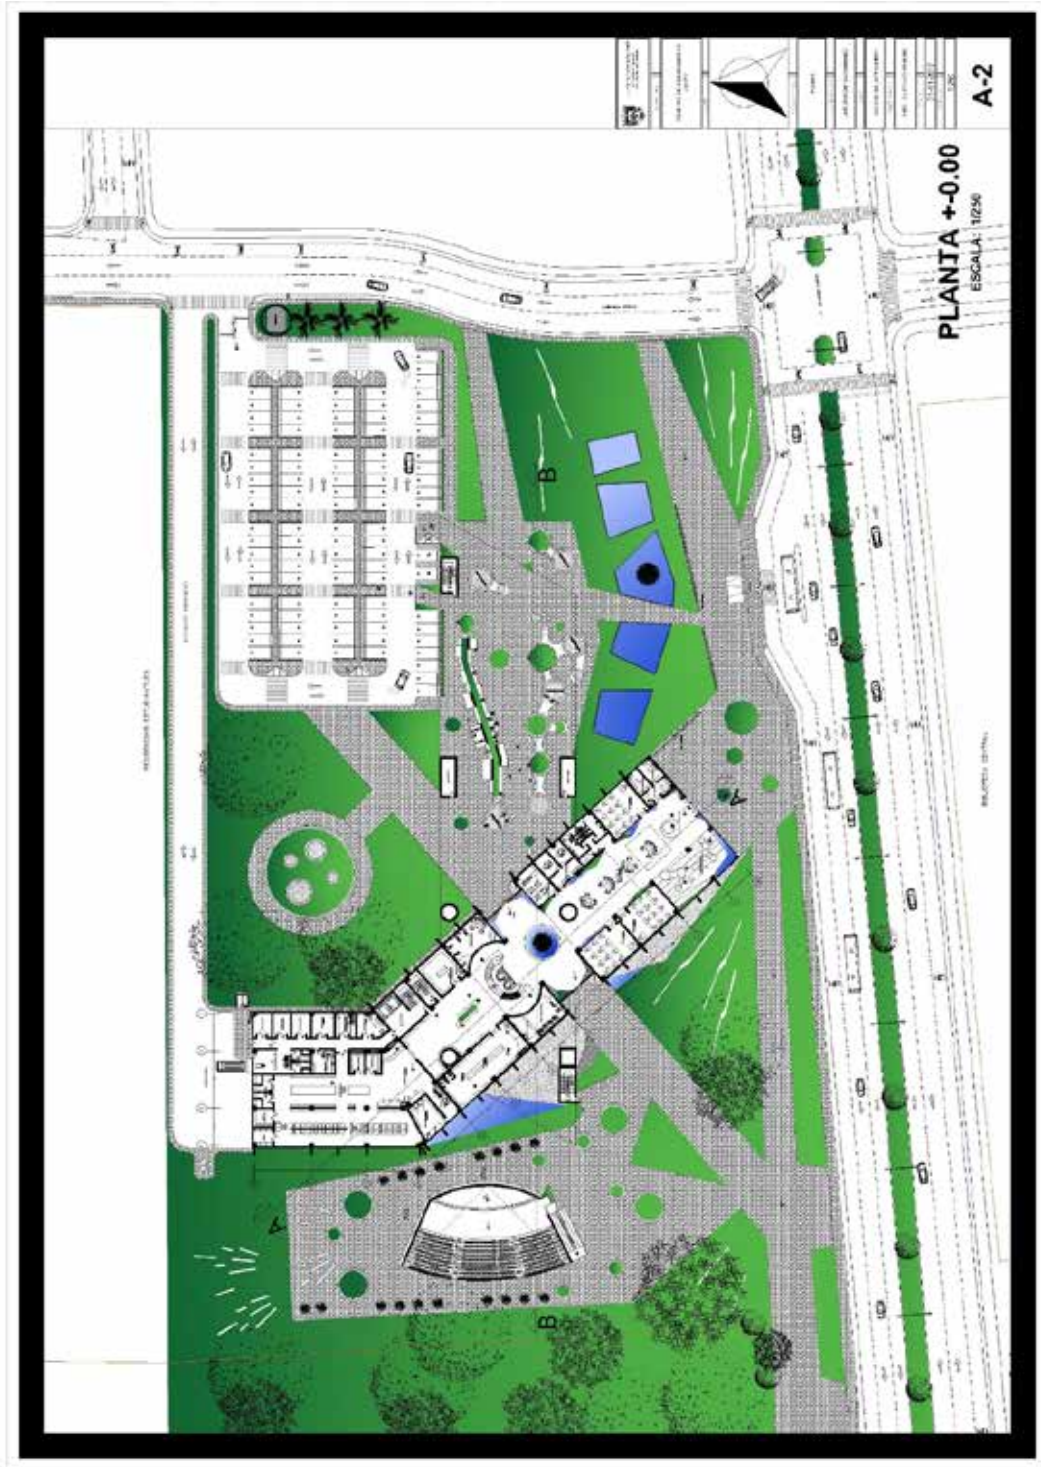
Planta Baja Nivel +- 0.00 (2018)
